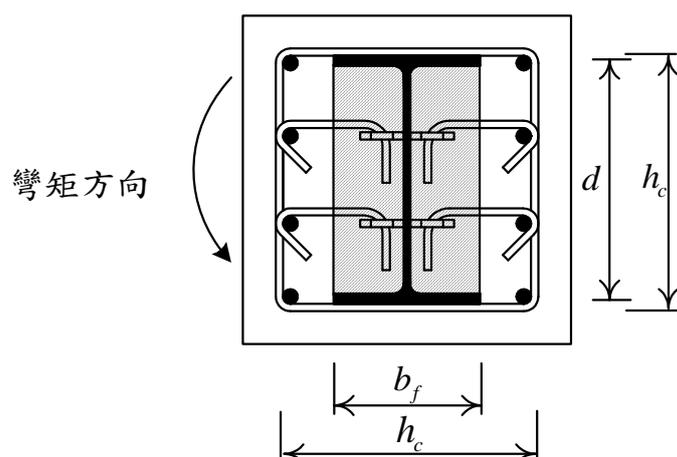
NSRC 斷面鋼骨所圍束之混凝土
